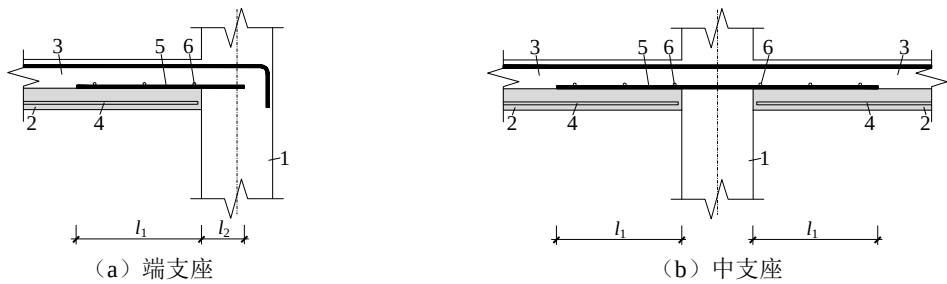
预制底板纵向受力钢筋不伸入支座构造示意图
